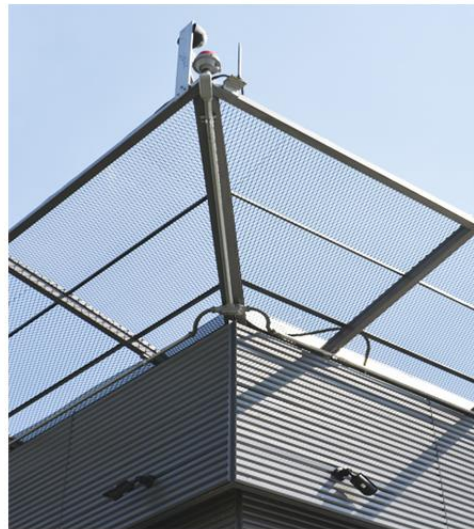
UBICACIÓN DE CÁMARAS EN EL EXTERIOR
